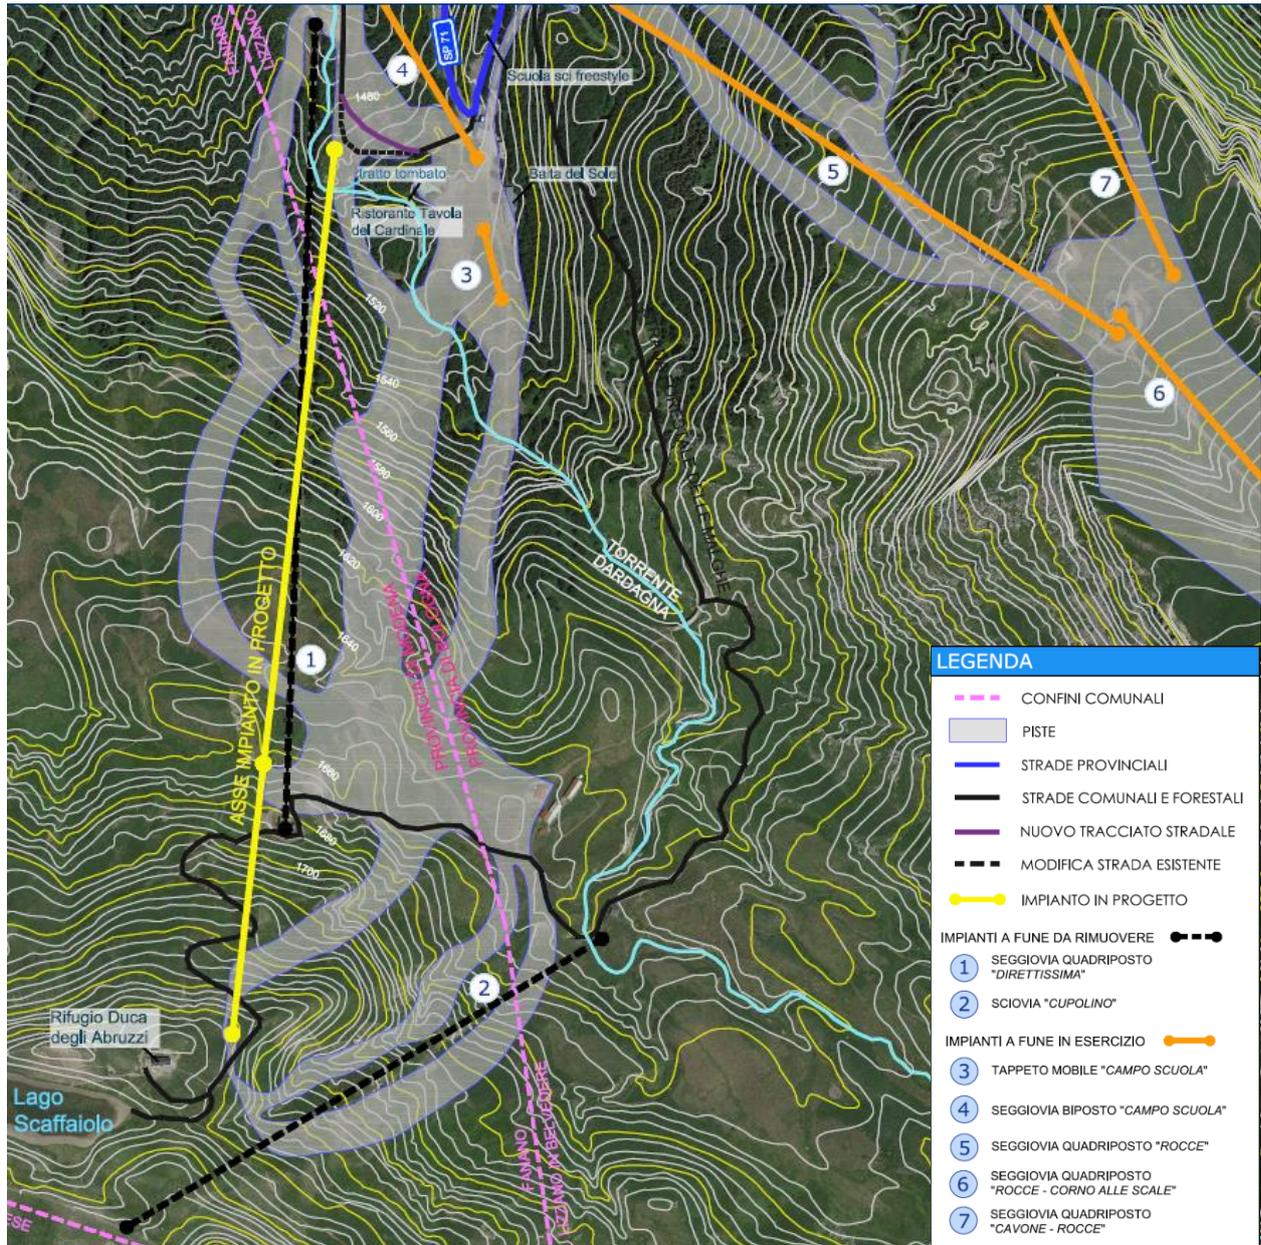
Planimetria con indicazione del tracciato degli impianti esistenti da rimuovere
